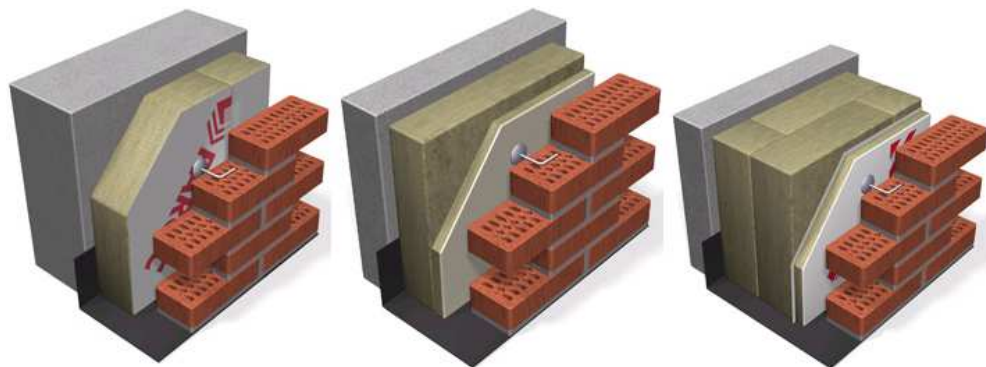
Erilaisia betonisandwich-elementtejä (Paroc).
